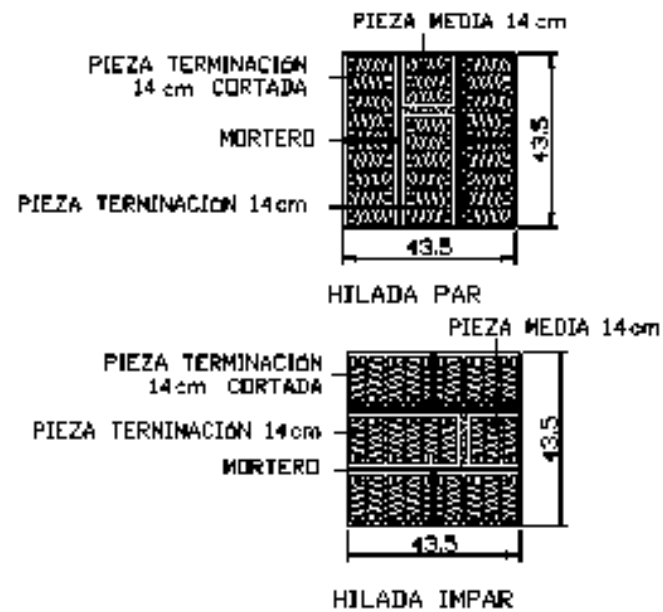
Pilastra de 45 cm de ancho y pilar de 45x45 cm.
